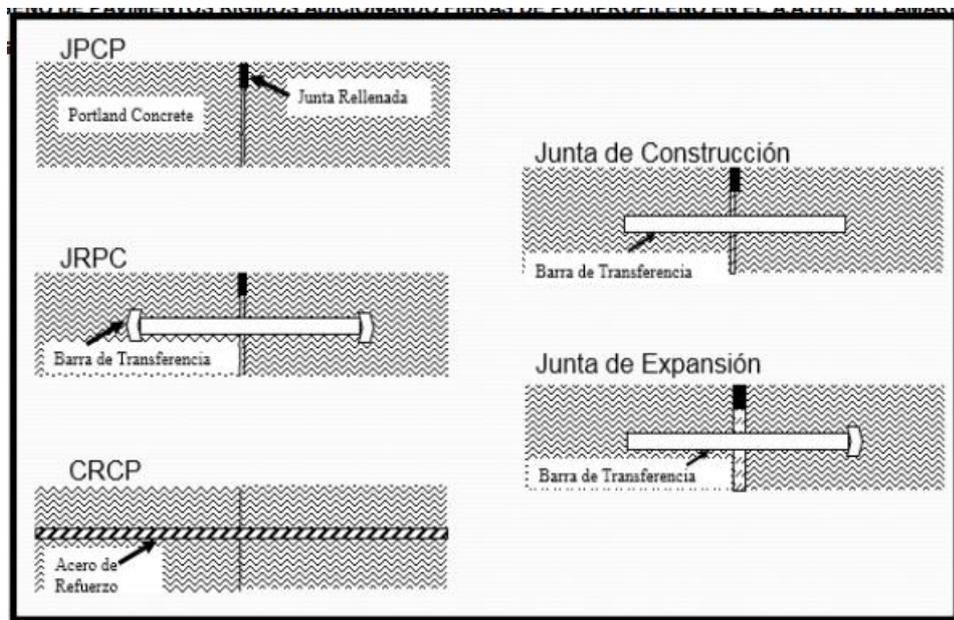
Losas reforzadas con barra de acero. Fuente Introducción a la Ingeniería de Pavimentos, Ing. Andres Sotil Ch.
